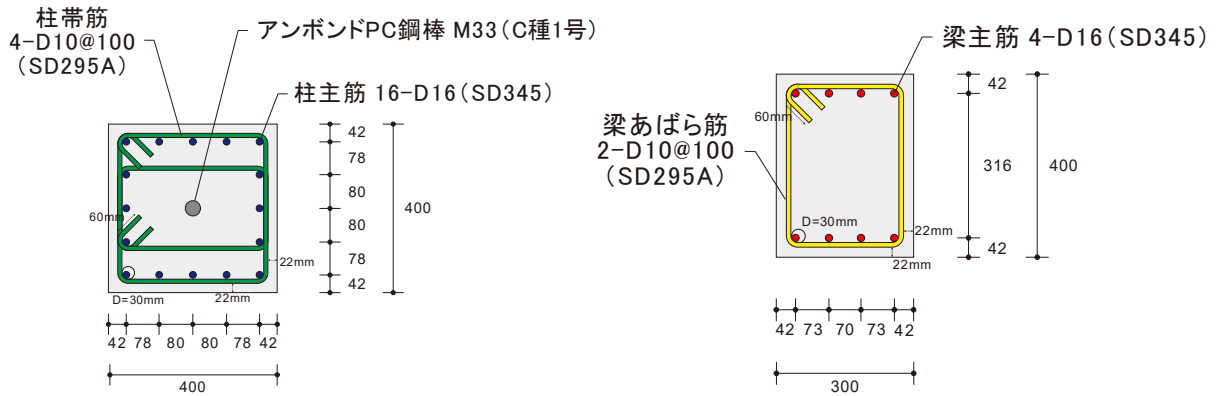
試験体 C の RC 柱、RC はりの断面図 (単位:mm)
